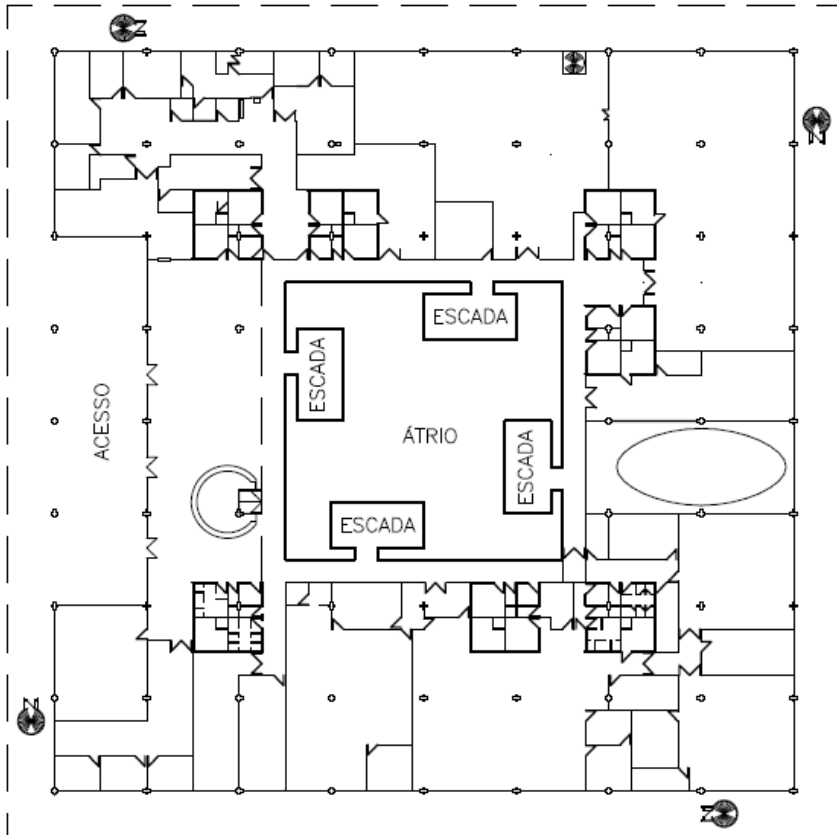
Edifício Sede da Eletrosul: planta baixa esquemática do pavimento térreo
